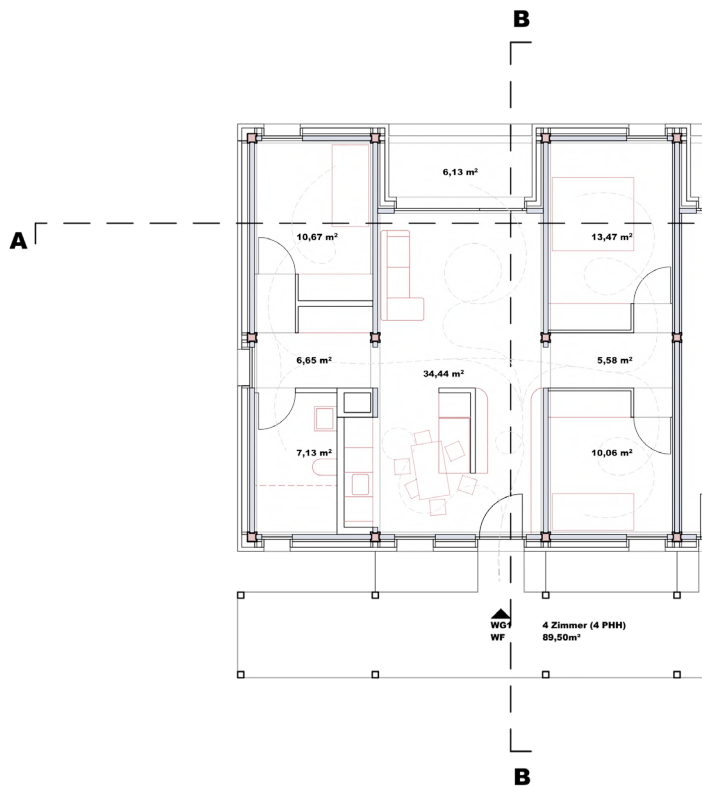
Ausschnitt des Referenzgebäudes C mit Wohnungsgrundriss für vier Personen
